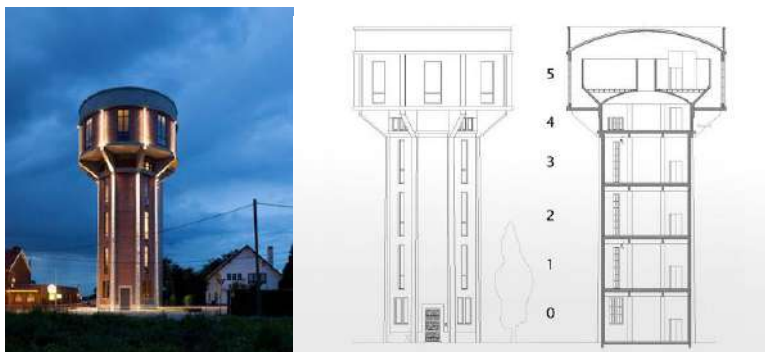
Реконструкция водонапорной башни под частный дом (Бельгия).
